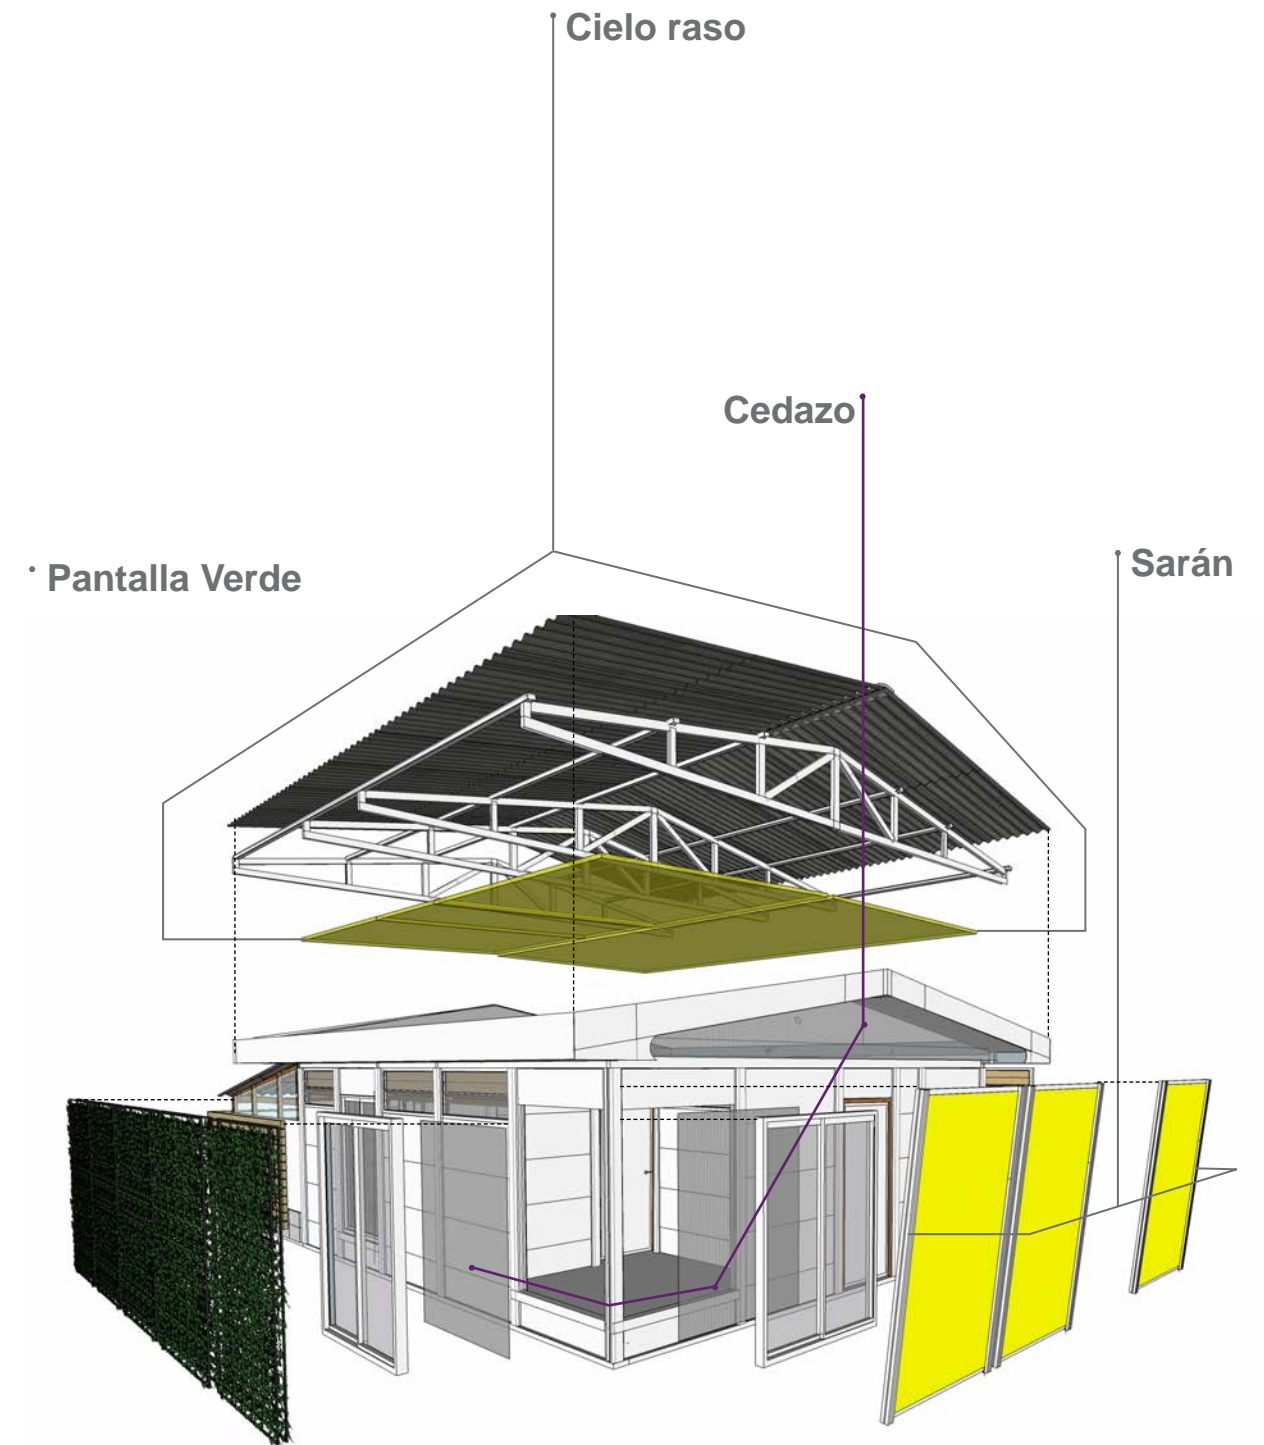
Despiece axonométrico mostrando materialidad de la adaptación. Creado por el autor.
